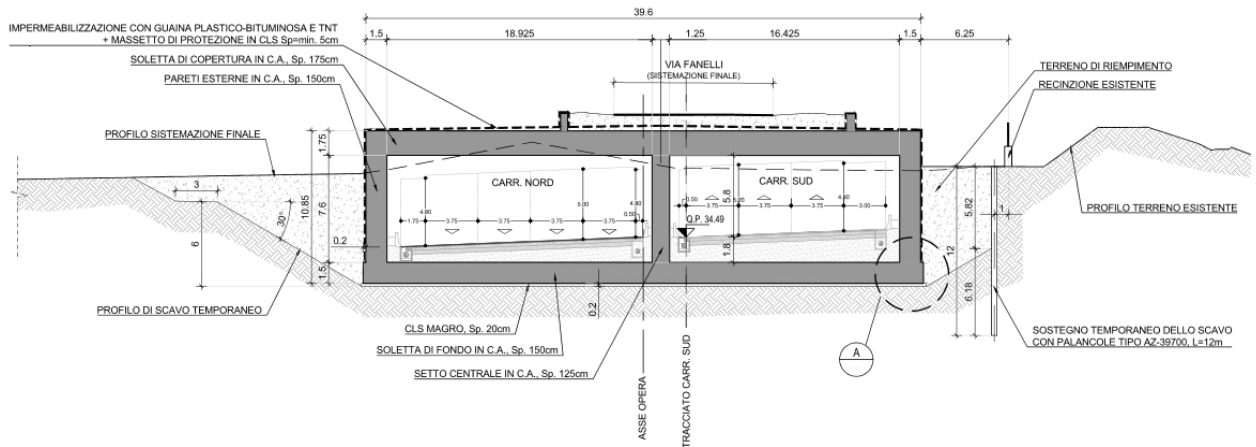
Esempio Galleria artificiale GA-01: Sezione trasversale
